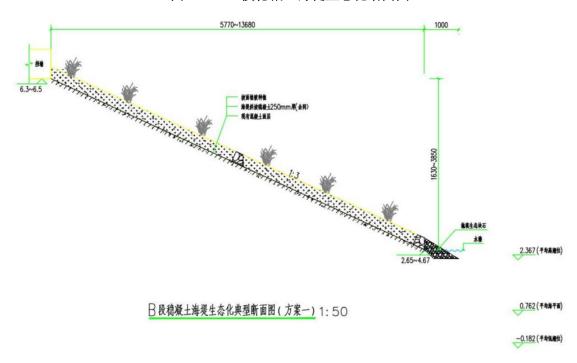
B~F 段稳凝土海堤生态化断面图
